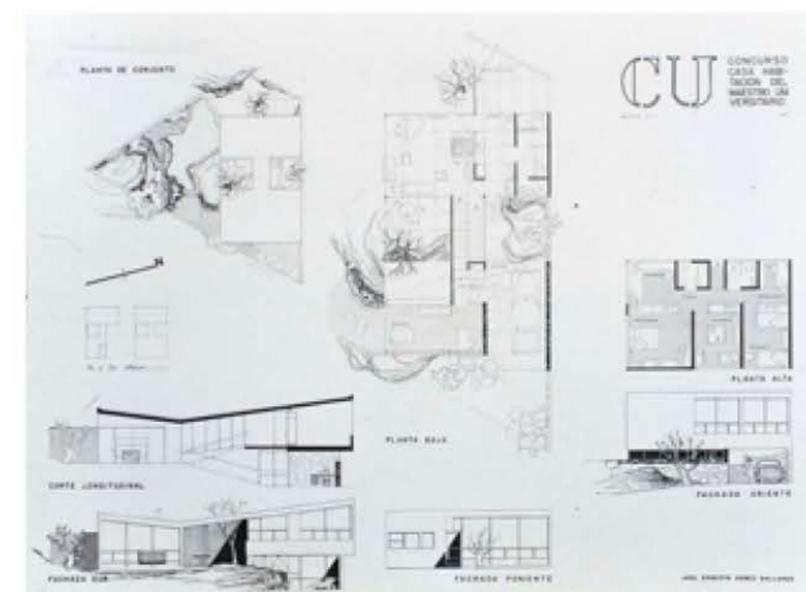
Concurso Casa Habitación del maestro universitario. Arq. Ernesto Gallardo, Pedregal de San Ángel, 1951. Es posible notar la disposición de la zona privadas en primer nivel y las zonas públicas en planta baja. El diseño dúplex del multifamiliar es similar en su organización espacial.
